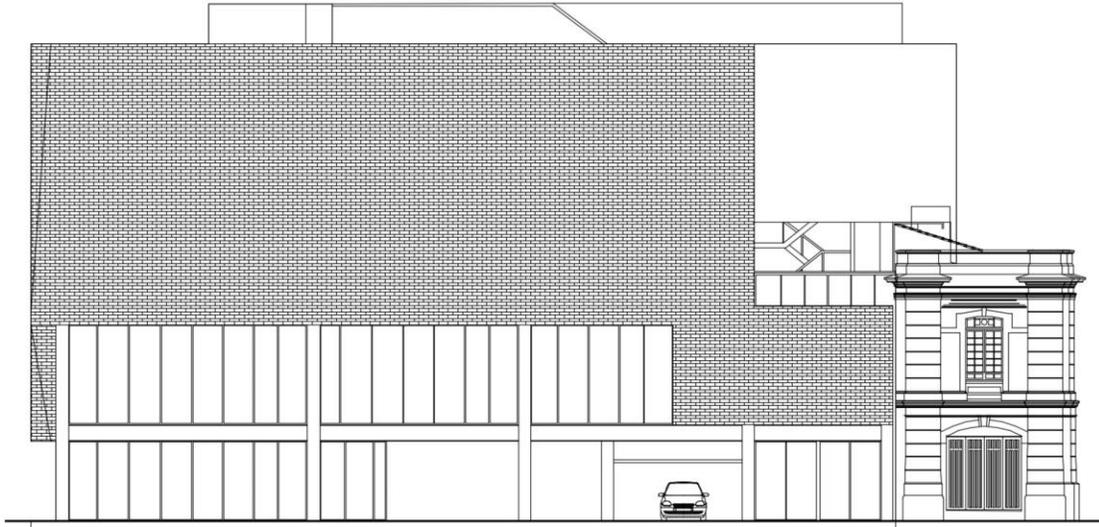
Fachada calle 10 – EDIFICIO CREATIVO
